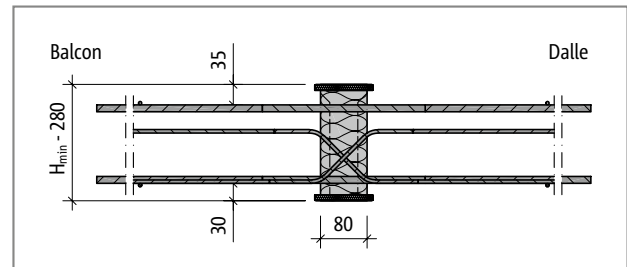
Schöck Isokorb® T Type D pour CV35 : Coupe du produit
